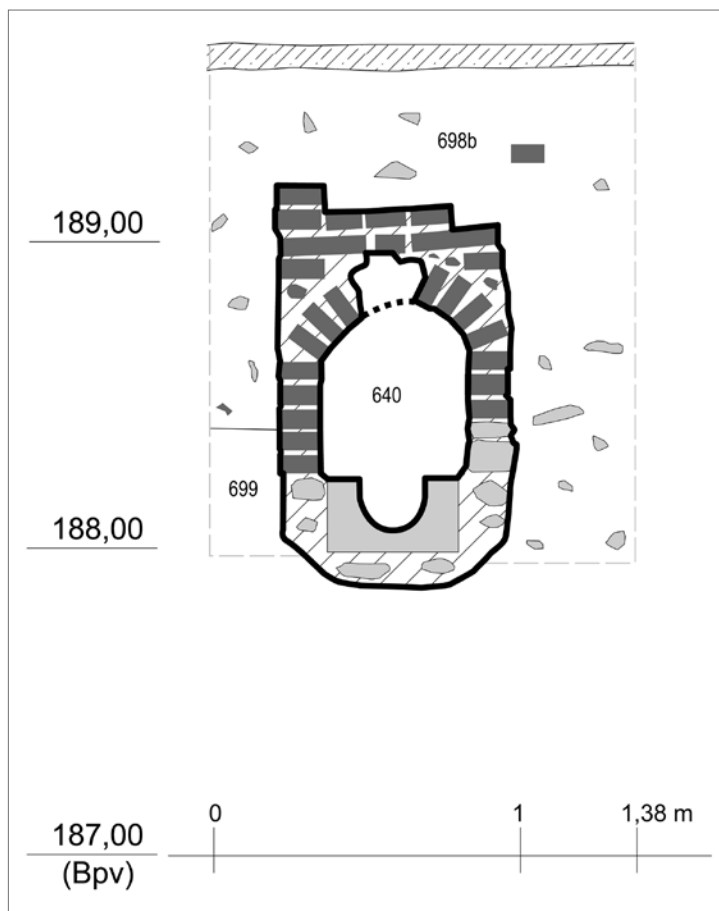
Klementinum – Wirtschaftshof, Grundstücksparzellennr. 82, Grundrissplan des frühbarocken Abwasserkanals (640) mit profiliertem Sandsteinbett. Grabung des NDG in Prag Nr. 1997/10, Sondierschnitt F, Plan 30. Zeichnung J. Havrda.
